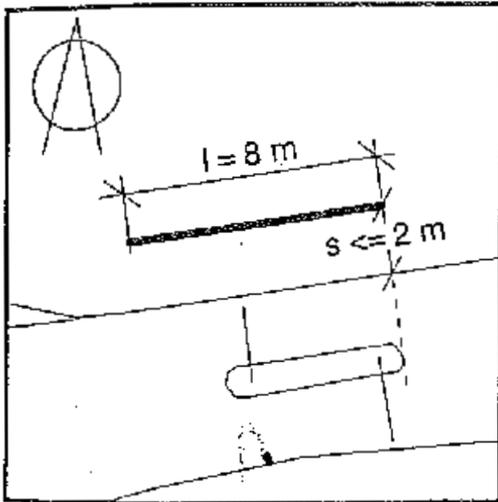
Lageskizze der mindestens 1,5 m hohen Lärmschutzwand,
